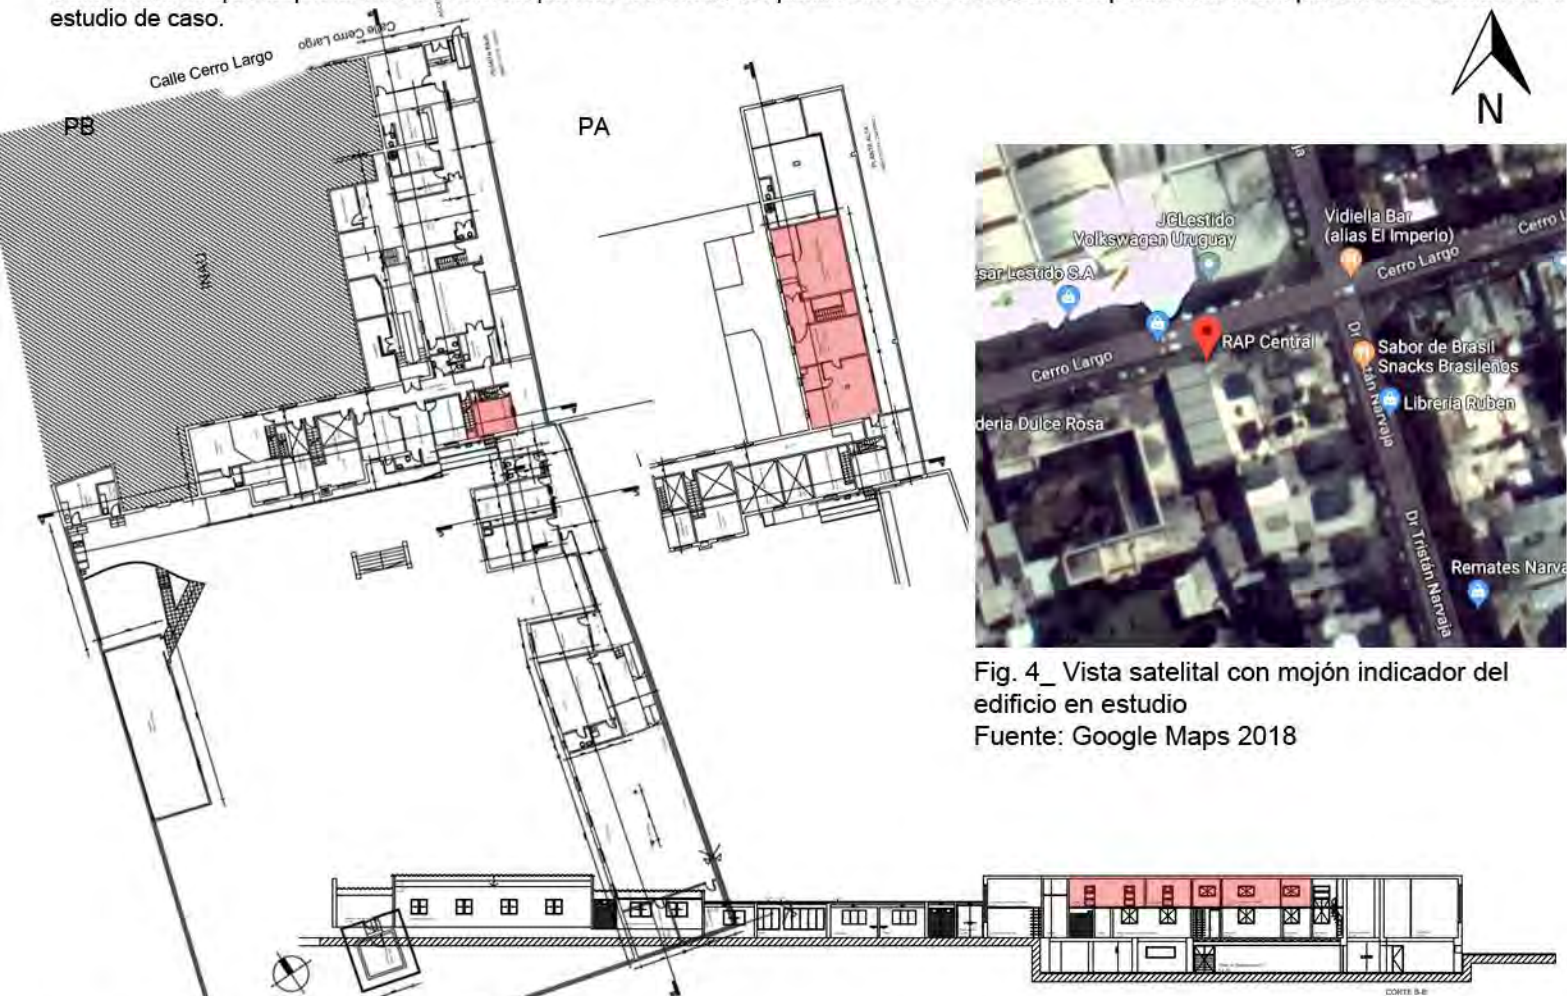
Plantas y alzado general de referencia, con la ubicación de las oficinas en estudio.
